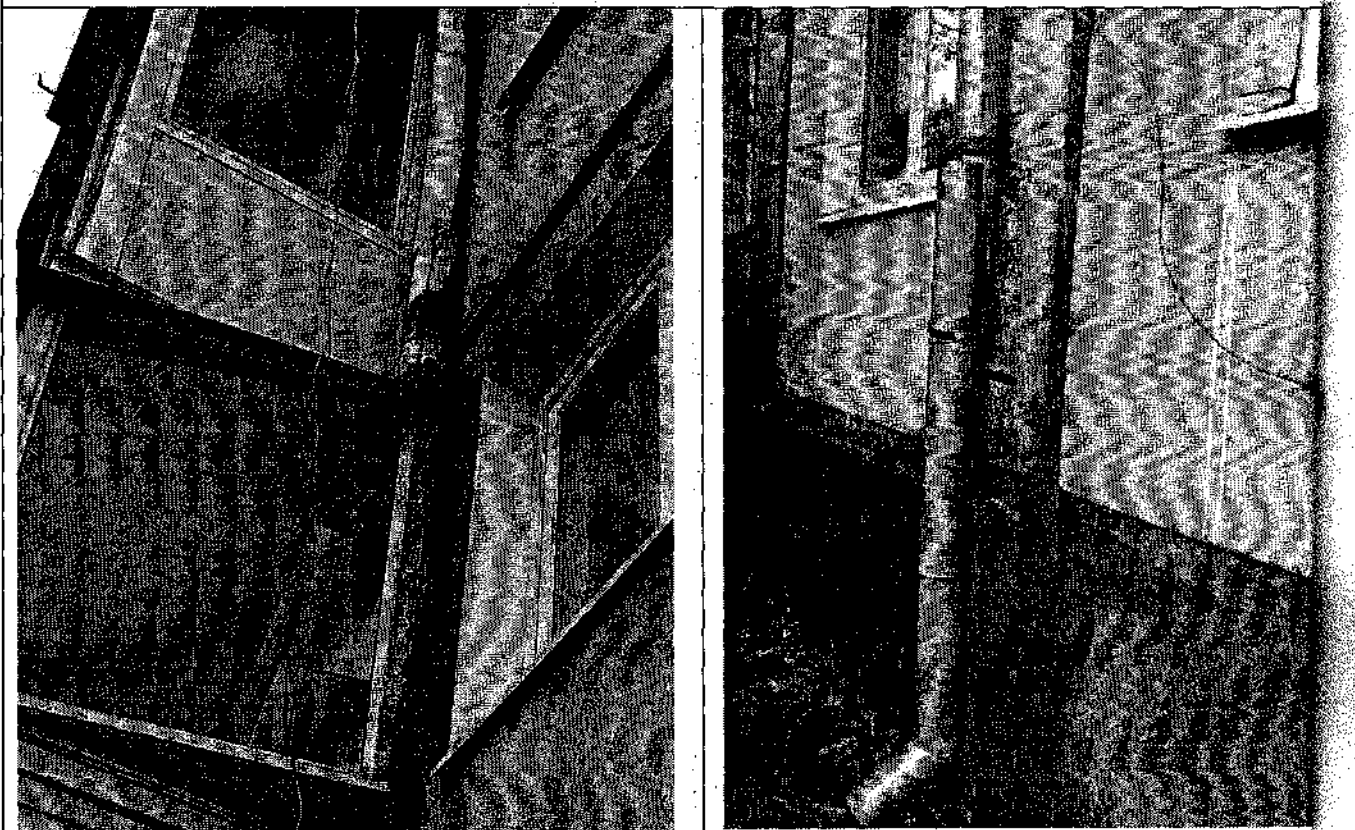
,8. Разрушение водосточной трубы. Замачивание наружных стен здания.
